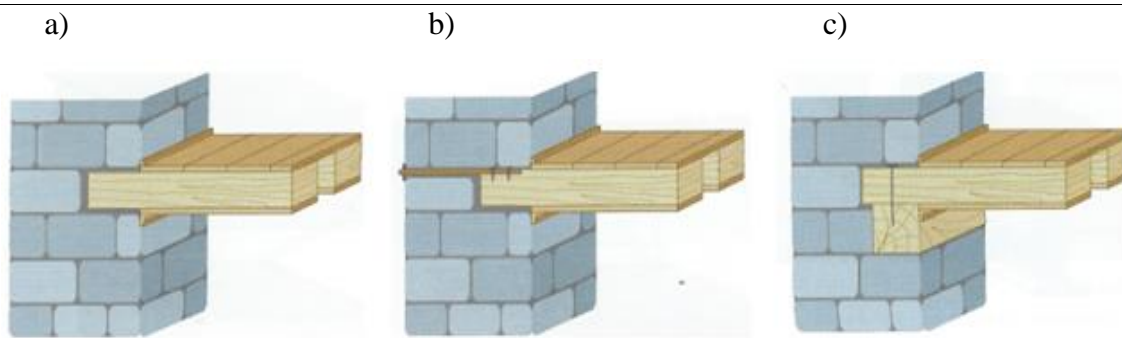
Apoio das vigas do pavimento [7]: a) Apoio da viga de madeira na parede de alvenaria de pedra; b) Ancoragem de viga de madeira em parede de alvenaria; c) Apoio do pavimento-parede através de frechal existente na parede
